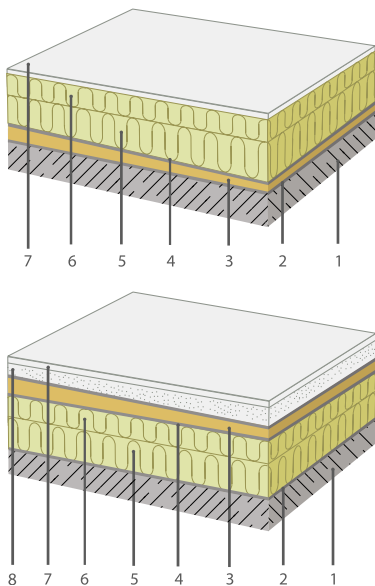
Устройство уклона плоского покрытия при основании плоского покрытия из железобетонной плиты:
